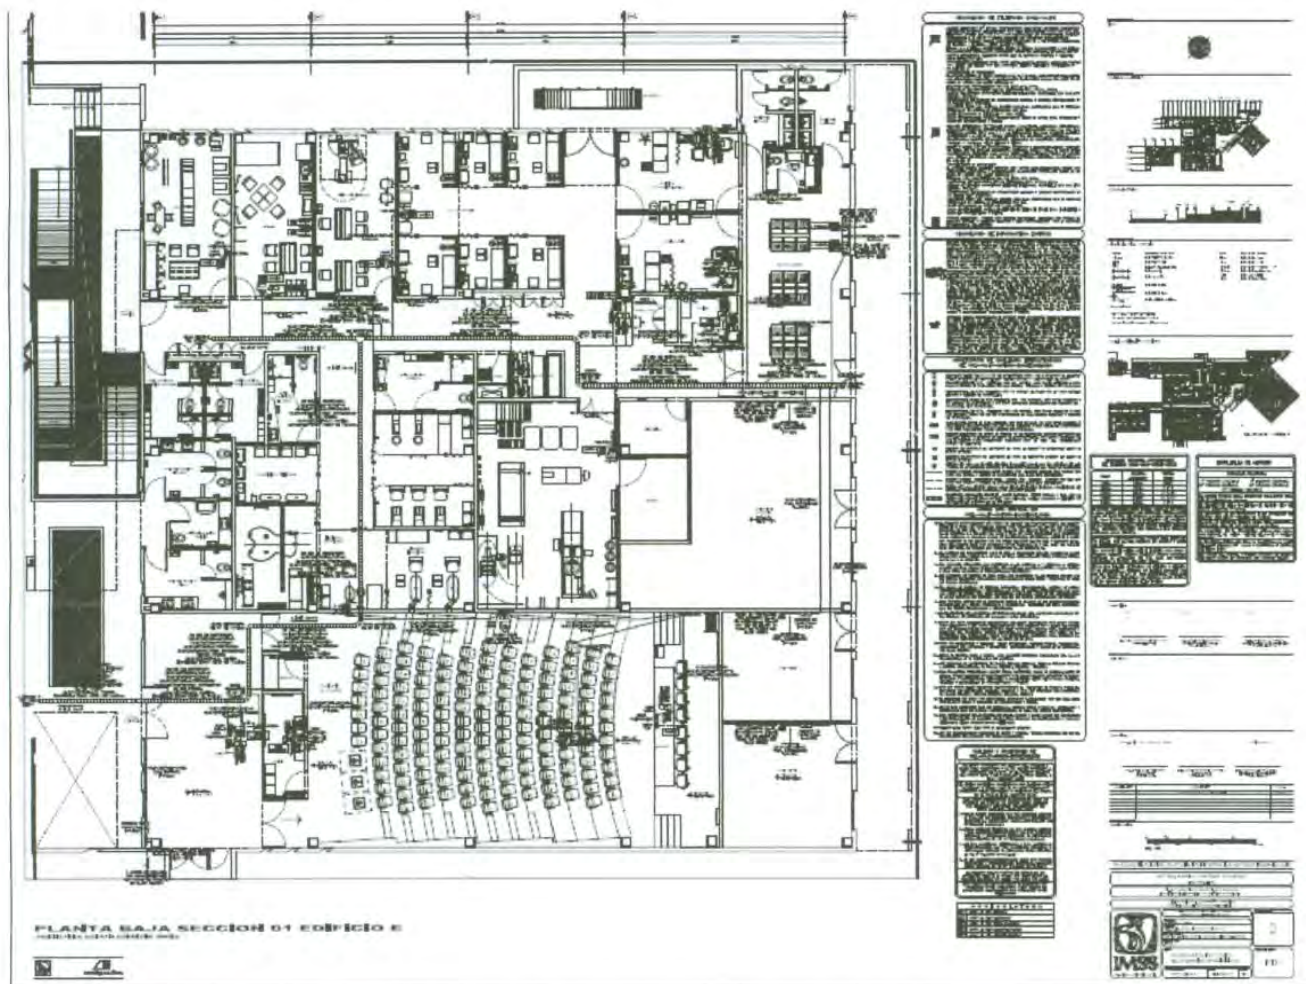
Plano Proyecto de C. Estructurado (Red), Telefonía (Ip), Informática (Datos) e Imagenología Sección 1, Planta baja
